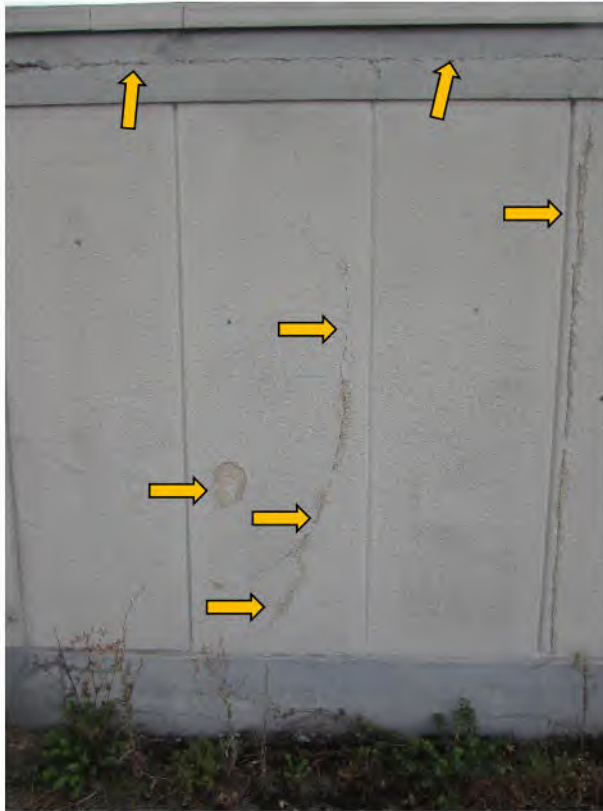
PKW-Fertigarage, Risse und Beschädigungen an der Fassade
